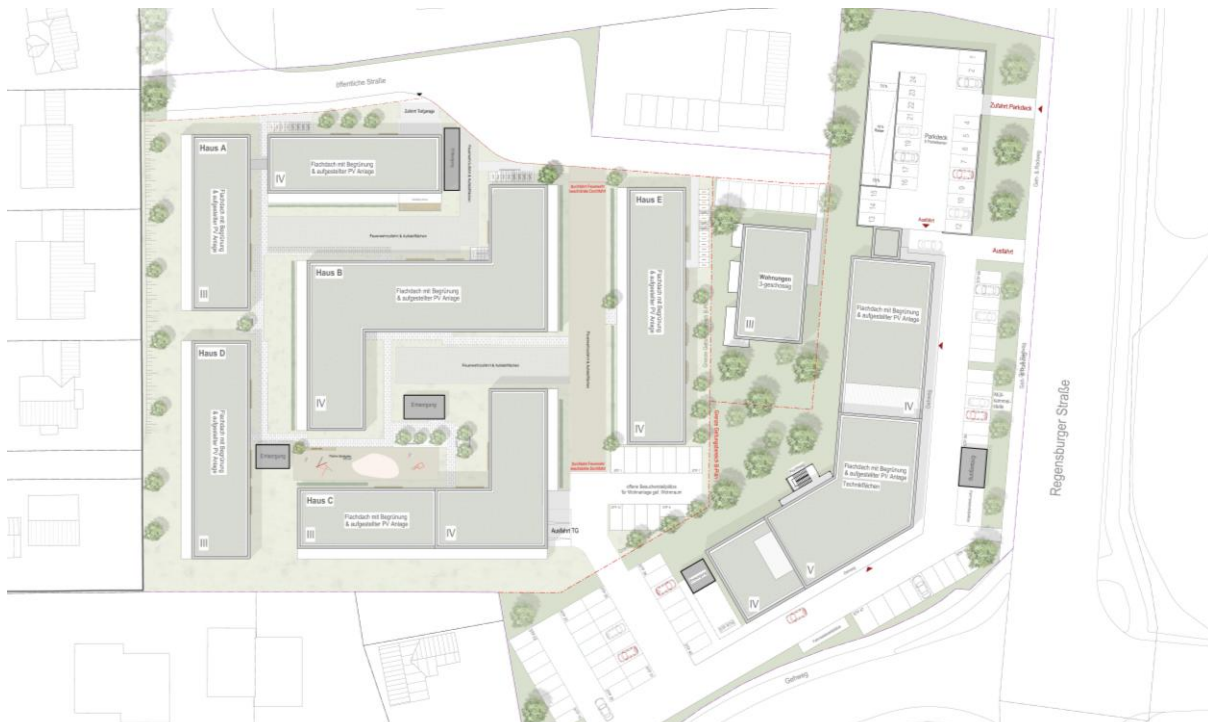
Auszug des Konzeptplans Südpark Schwandorf (vgl. Teil C, Anlage 1), Quelle: Bauunternehmen Gebr. Donhauser Bau GmbH & Co. KG, Stand 06.05.2026, o. M.
